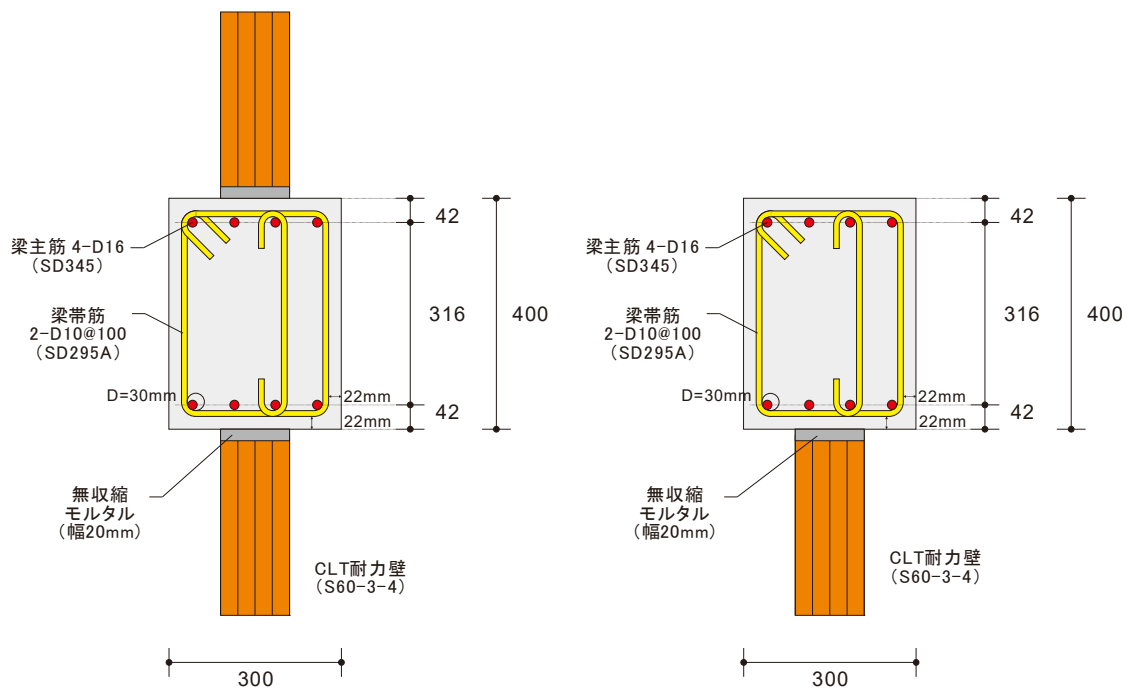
試験体 WB の CLT 耐力壁取り付け後のはりの断面図
